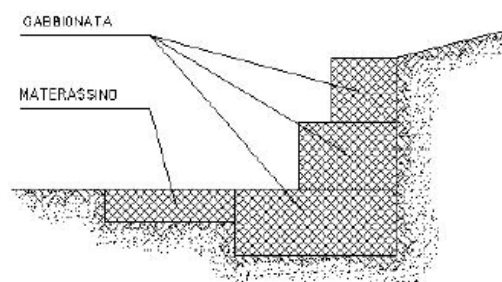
Sezione tipo di un versante sistemato con gabbioni
